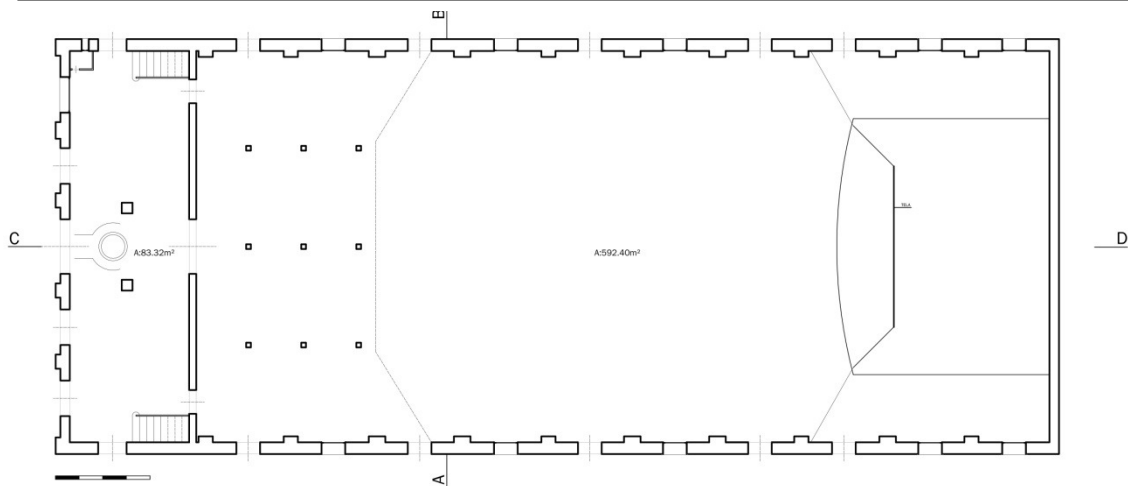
Planta Baixa Pavimento Térreo, Reforma 1947
